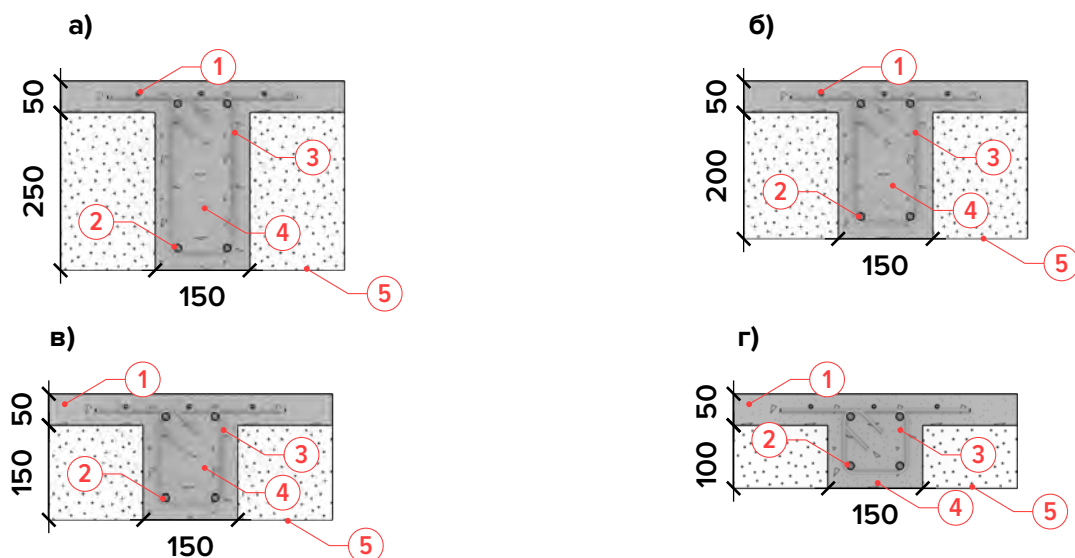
Типовое сечение ребер сборно-монолитного перекрытия
